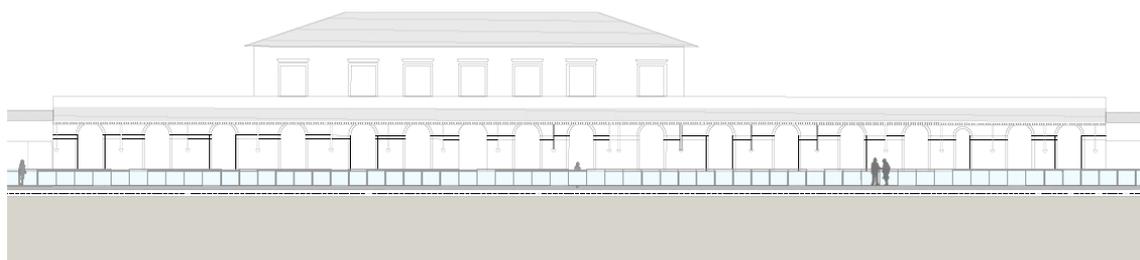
Prospetto Fabbricato viaggiatori esistente a seguito dell'innalzamento
